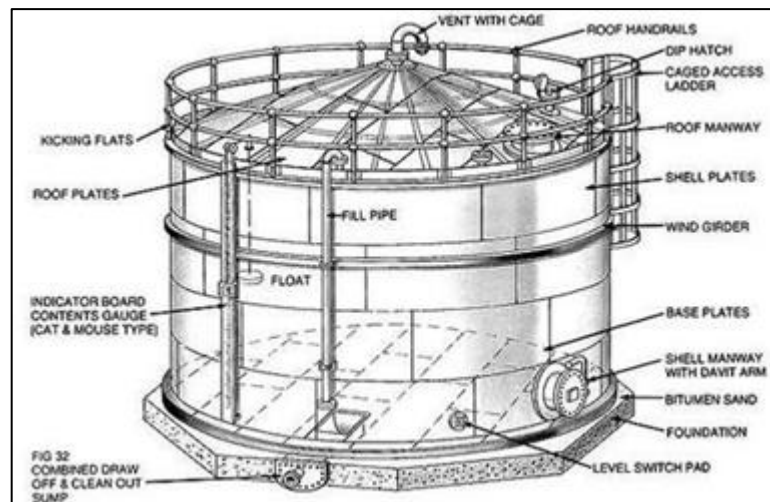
Réservoir à toit fixe supporté par plusieurs poteaux.
